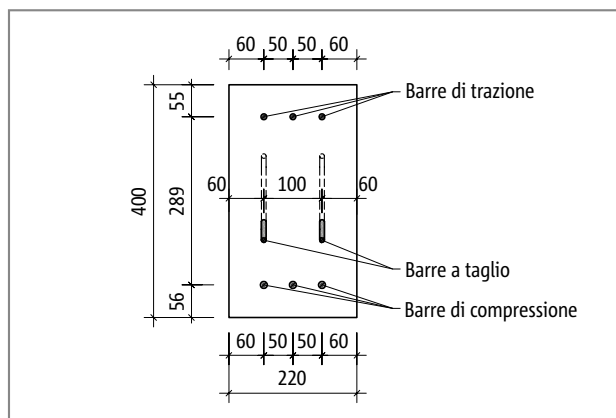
Schöck Isokorb® tipo SXT1: vista dell'elemento
